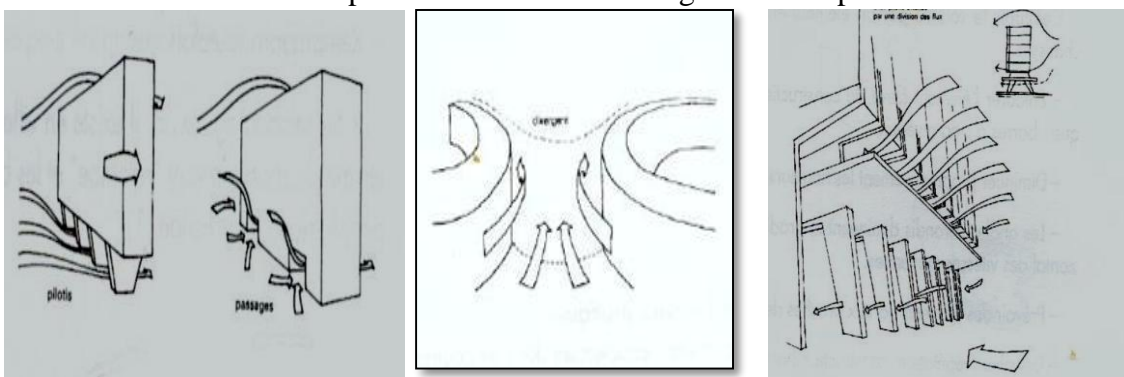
orientation des immeubles sur pilotis ou avec trous par rapport aux vents
